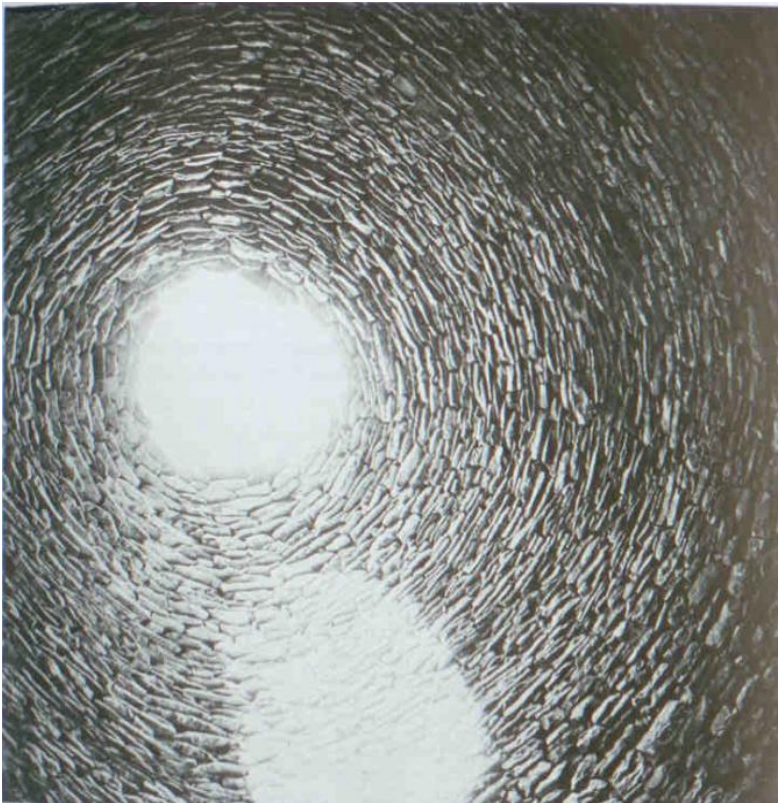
Construcción con piedra sin mortero en el Salento (Italia) Fuente: AMBROSI, Angelo.
